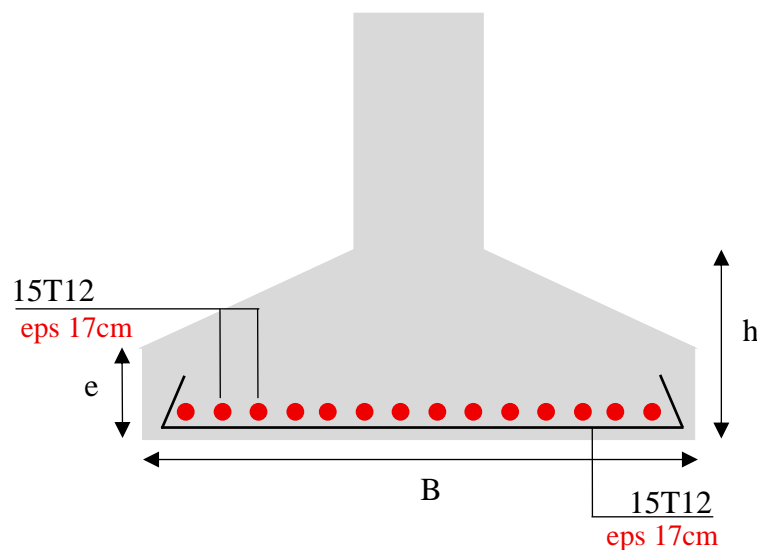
Schéma de ferrailage de semelle isolée.
